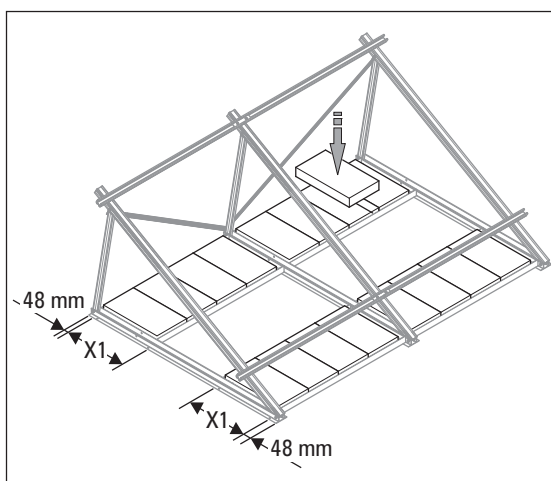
Einlegen der Betonplatten (EKSV26A)
